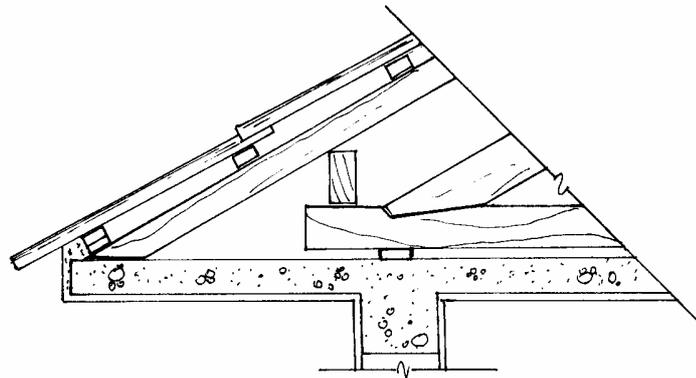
Tipo de beiral com laje. Fonte: FACENS, 2001.
